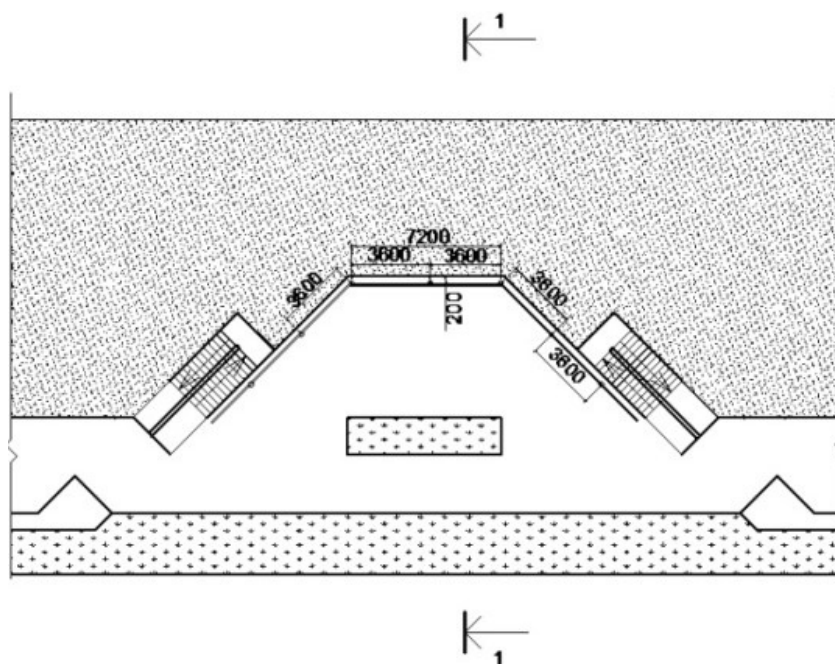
Типовая площадка набережной с расстановкой винтовых свай.
